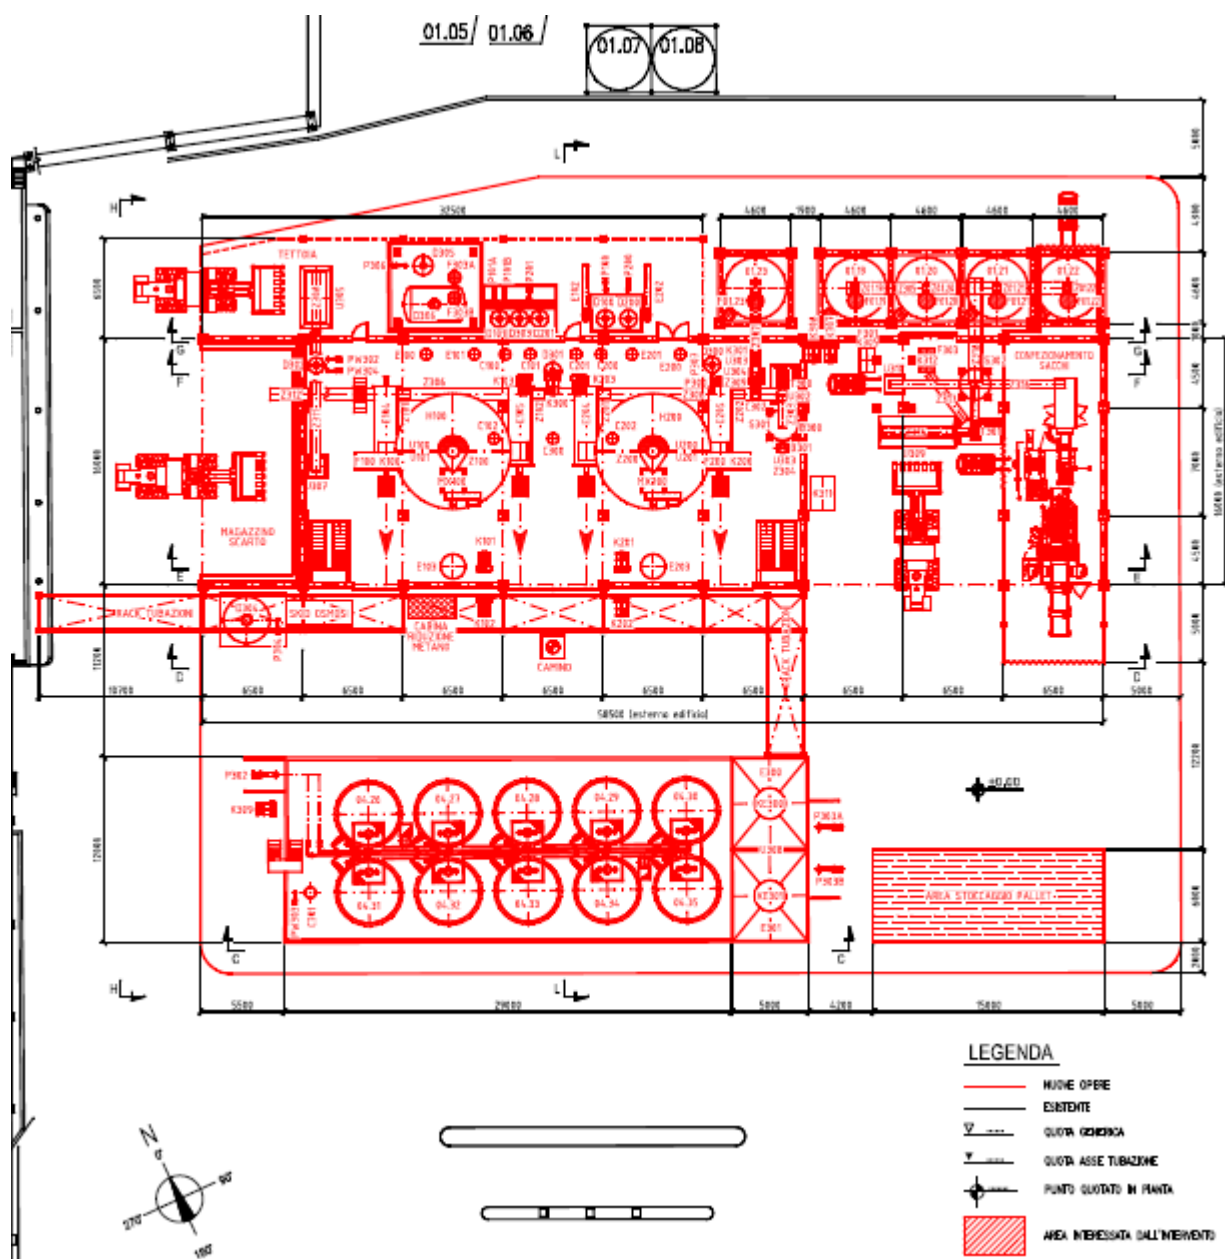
Planimetria dell'impianto di progetto (zona produzione)
